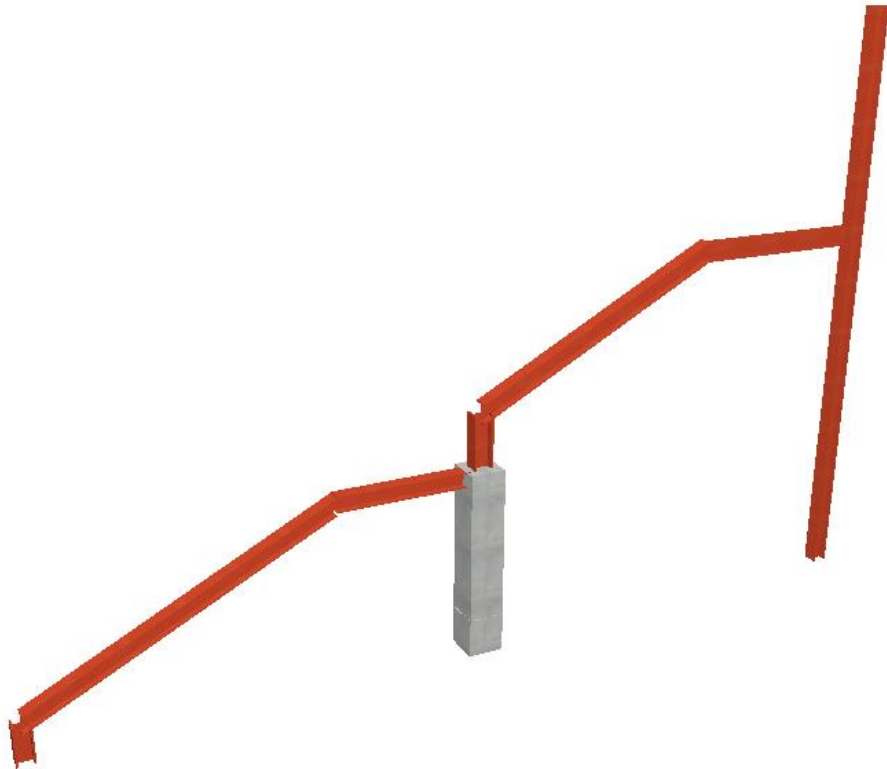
Pórtico tipo de la estructura de graderío. Fuente: Propia
